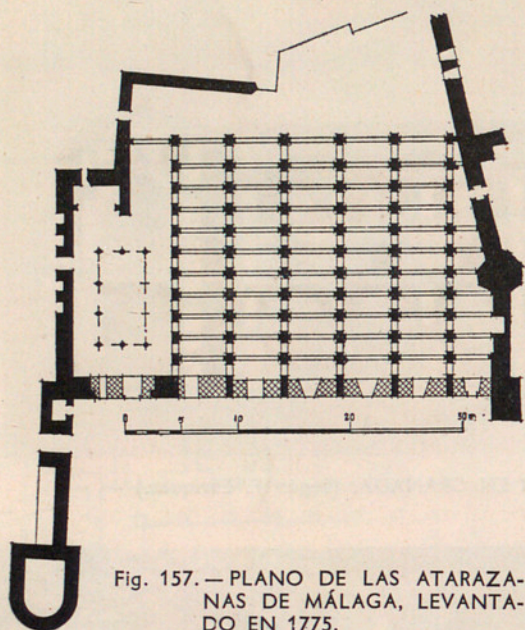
PLANO DE LAS ATARAZANAS DE MÁLAGA, LEVANTADO EN 1775.
